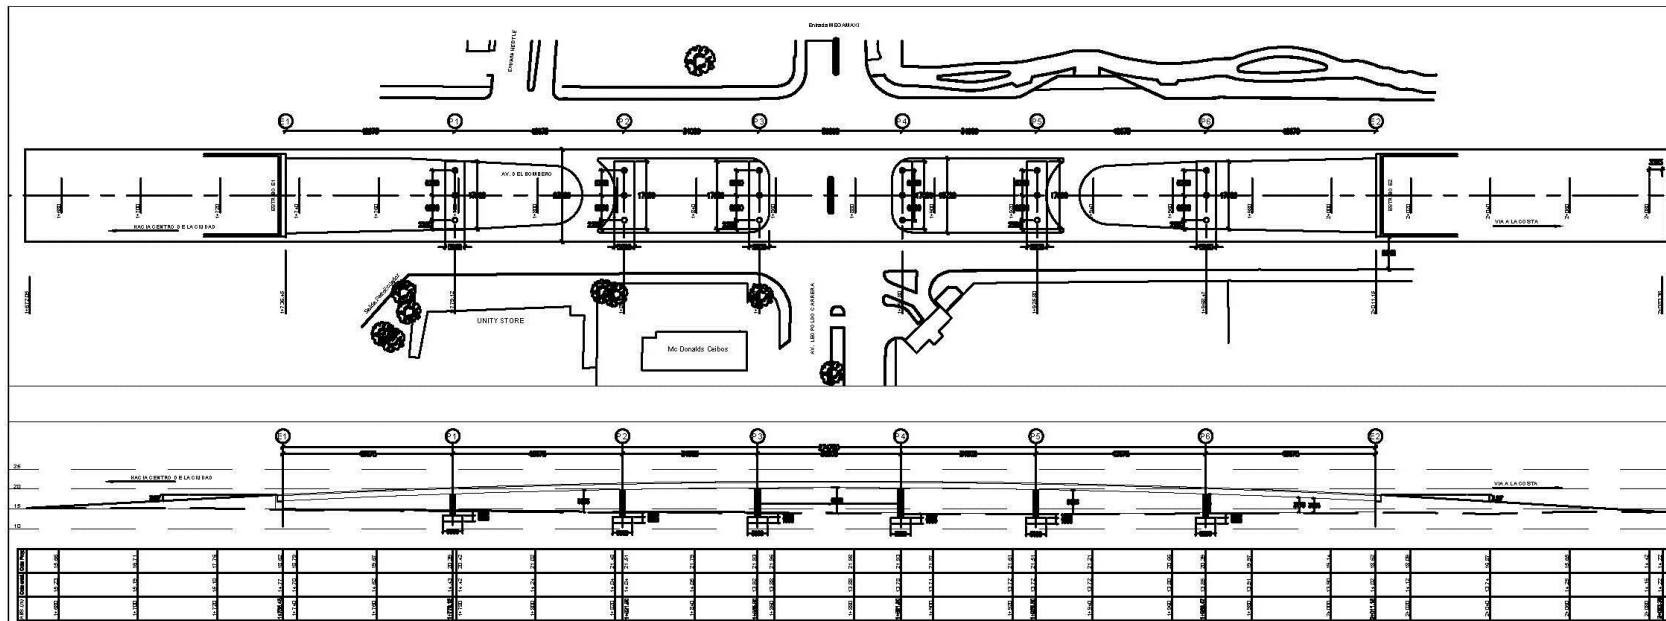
Detalle de la vista longitudinal y en planta del paso elevado alternativa 1
